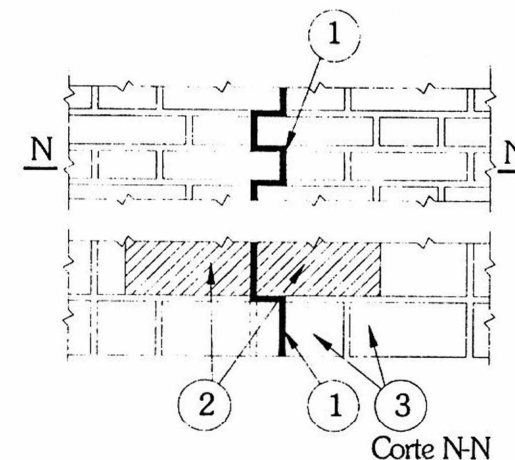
Junta de dilatación en muro con ladrillos a la vista y estructura de H°A°.
